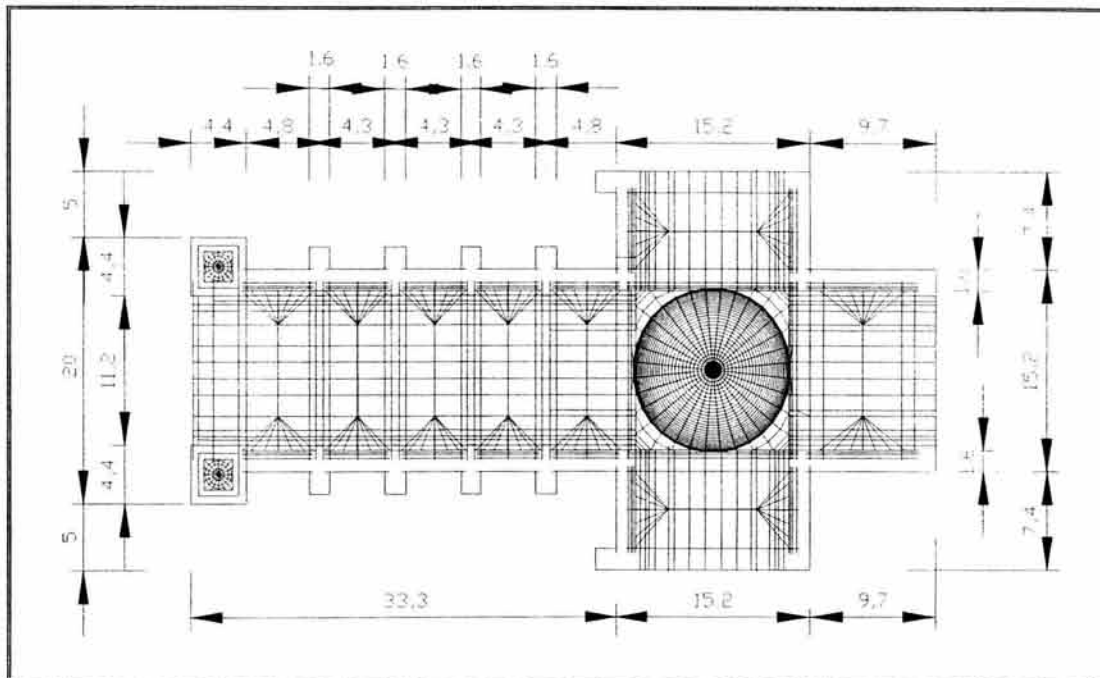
Planta cubierta de iglesia en cruz latina (m).
